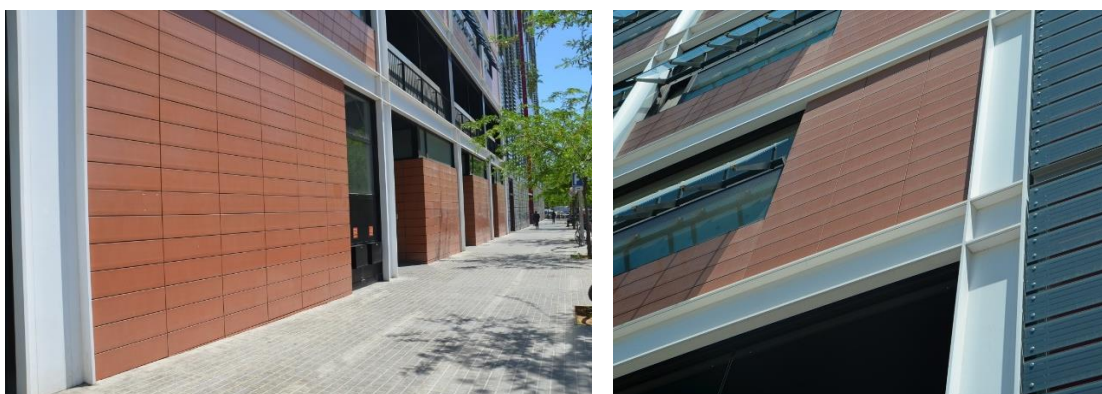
Ausencia de entrada de aire en el arranque de la fachada (pegada al suelo); sectorización de la fachada (derecha). Fuente: foto de la autora, 2014.
